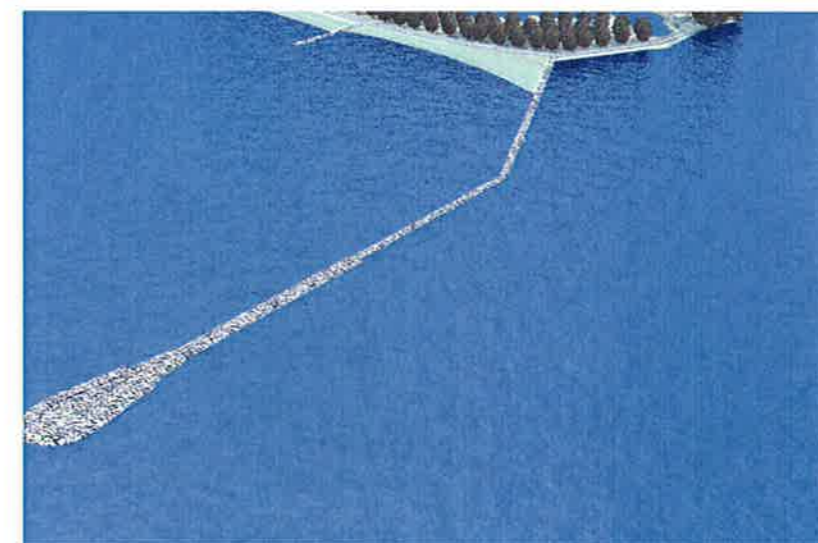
area di cantiere alla bocca di Chioggia: vista da mare
